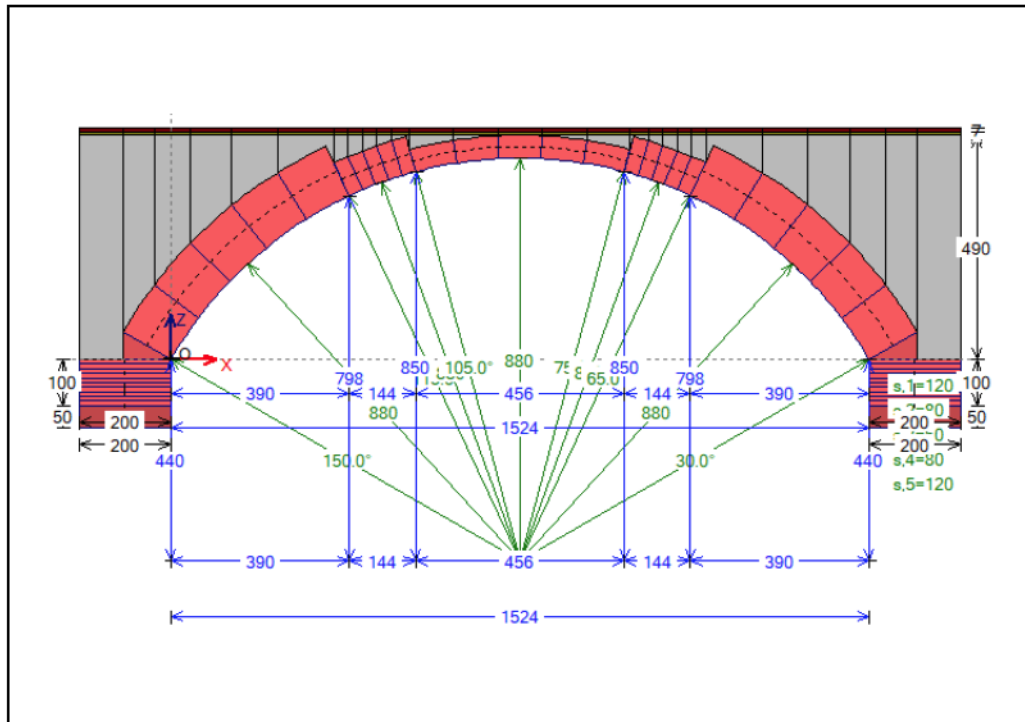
Geometria degli elementi portanti in muratura (cm) con rinfianchi e rappresentazione schematica del sottofondo e della pavimentazione.
